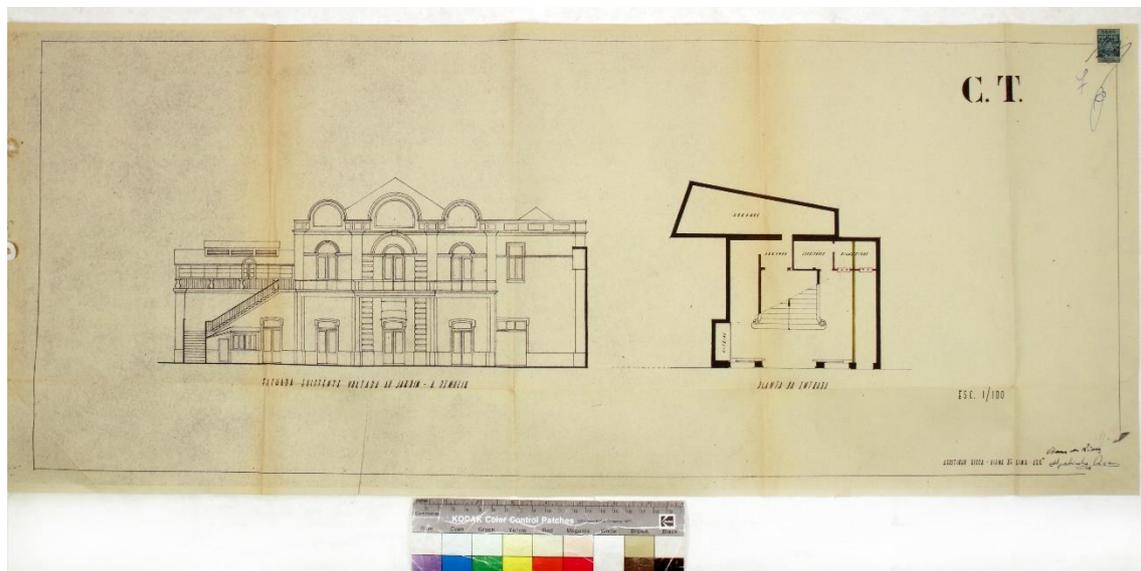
Fachada existente voltada ao Jardim para demolir; Planta da Entrada ao nível da Rua Dr. Ricardo Jorge
